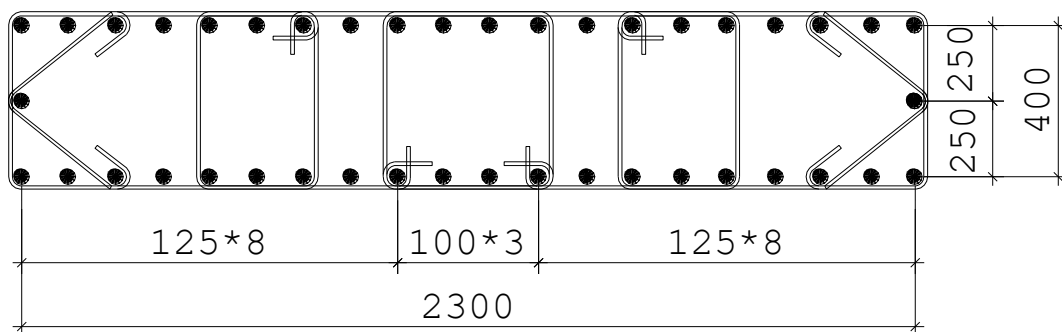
Посилення пілону на випадок обвалення частини будівлі
